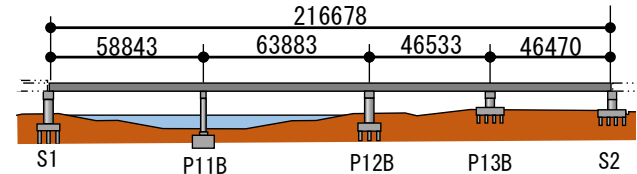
解析対象の鋼箱桁橋側面図(単位 mm)
